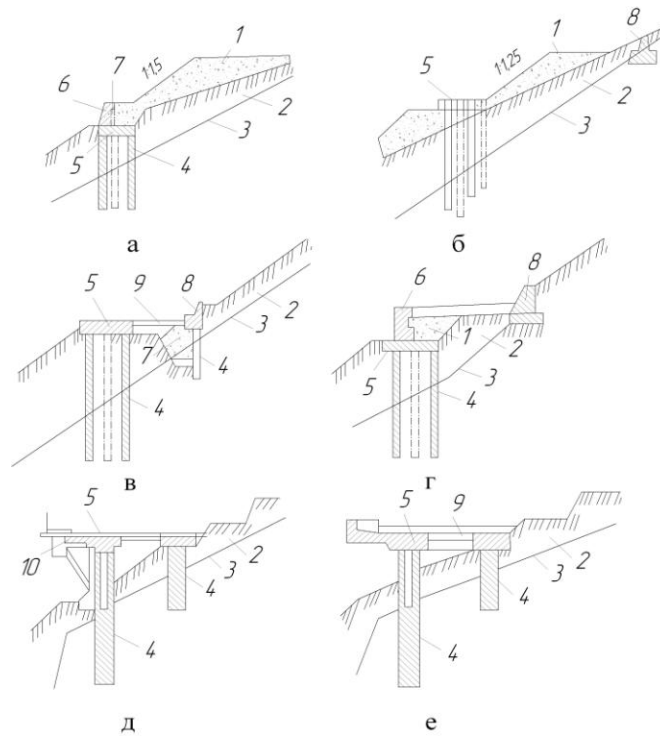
Схеми закріплення земляного полотна бетонними палями на ділянках зсувів: а – насип із нижньою підпірною стінкою на пальному ростверку; б – насип із опорним пальовим ростверком біля подошви; в, г – дорога на полиці з пальовим ростверком, з'єднаним горизонтальним анкерним тяжем із верхньою підпірною стінкою; д, е – протизсувні конструкції у вигляді балконів та естакад; (1 – насип; 2 – масив зсуву; 3 – поверхня ковзання; 4 – несучі буронабивні залізобетонні палі; 5 – залізобетонний ростверк; 6 – нижня підпірна стінка; 7 – дренаж; 8 – верхня підпірна стінка; 9 – анкерний тяж; 10 – залізобетонний балкон)
